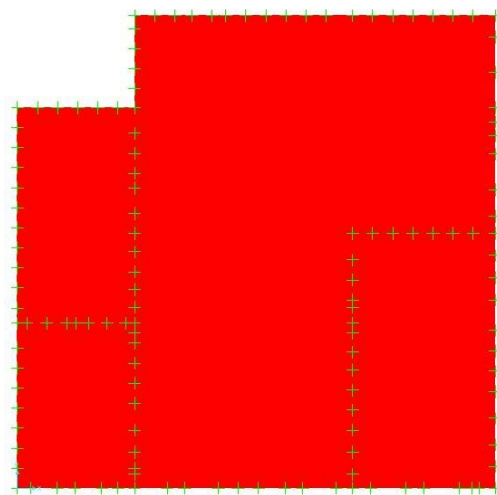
Vista em planta das condições de apoio consideradas no modelo
